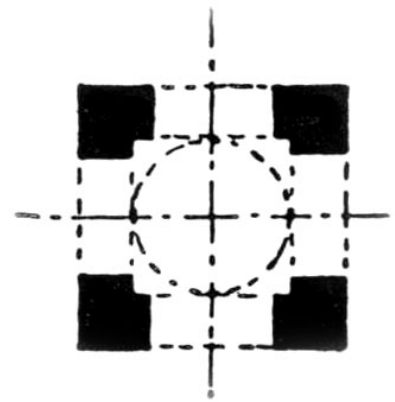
Grundriss Čahār Jāq/Djerre
